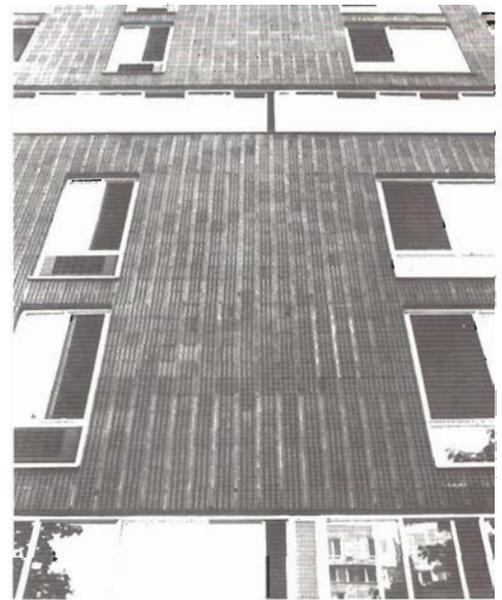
La fachada del edificio de viviendas de Roosevelt Island de J. L. Sert tiene una composición horizontal marcada por el pasillo de acceso a las viviendas que subraya el sistema constructivo de apoyo en un vuelo de perfil de acero.
